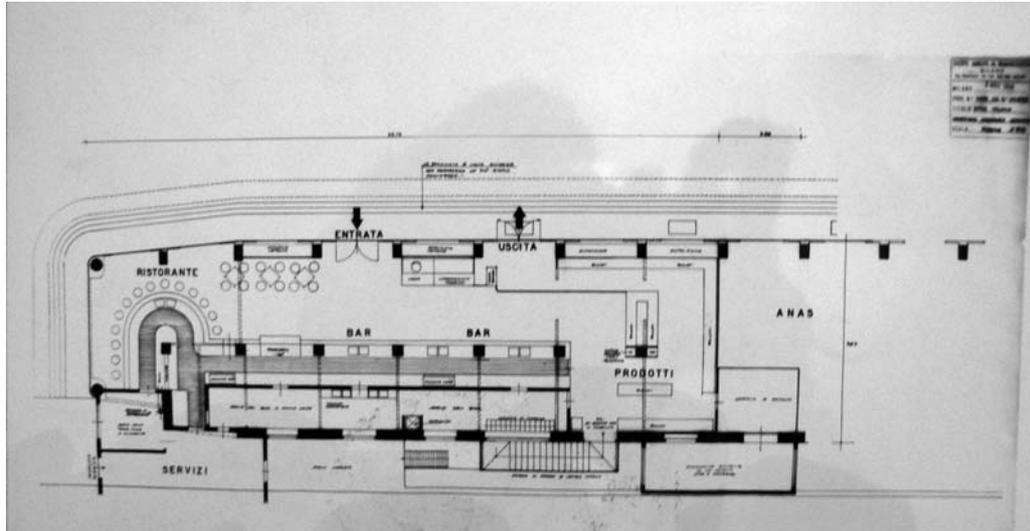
La pianta del piano terra con lo spazio ristoro (AAB)
